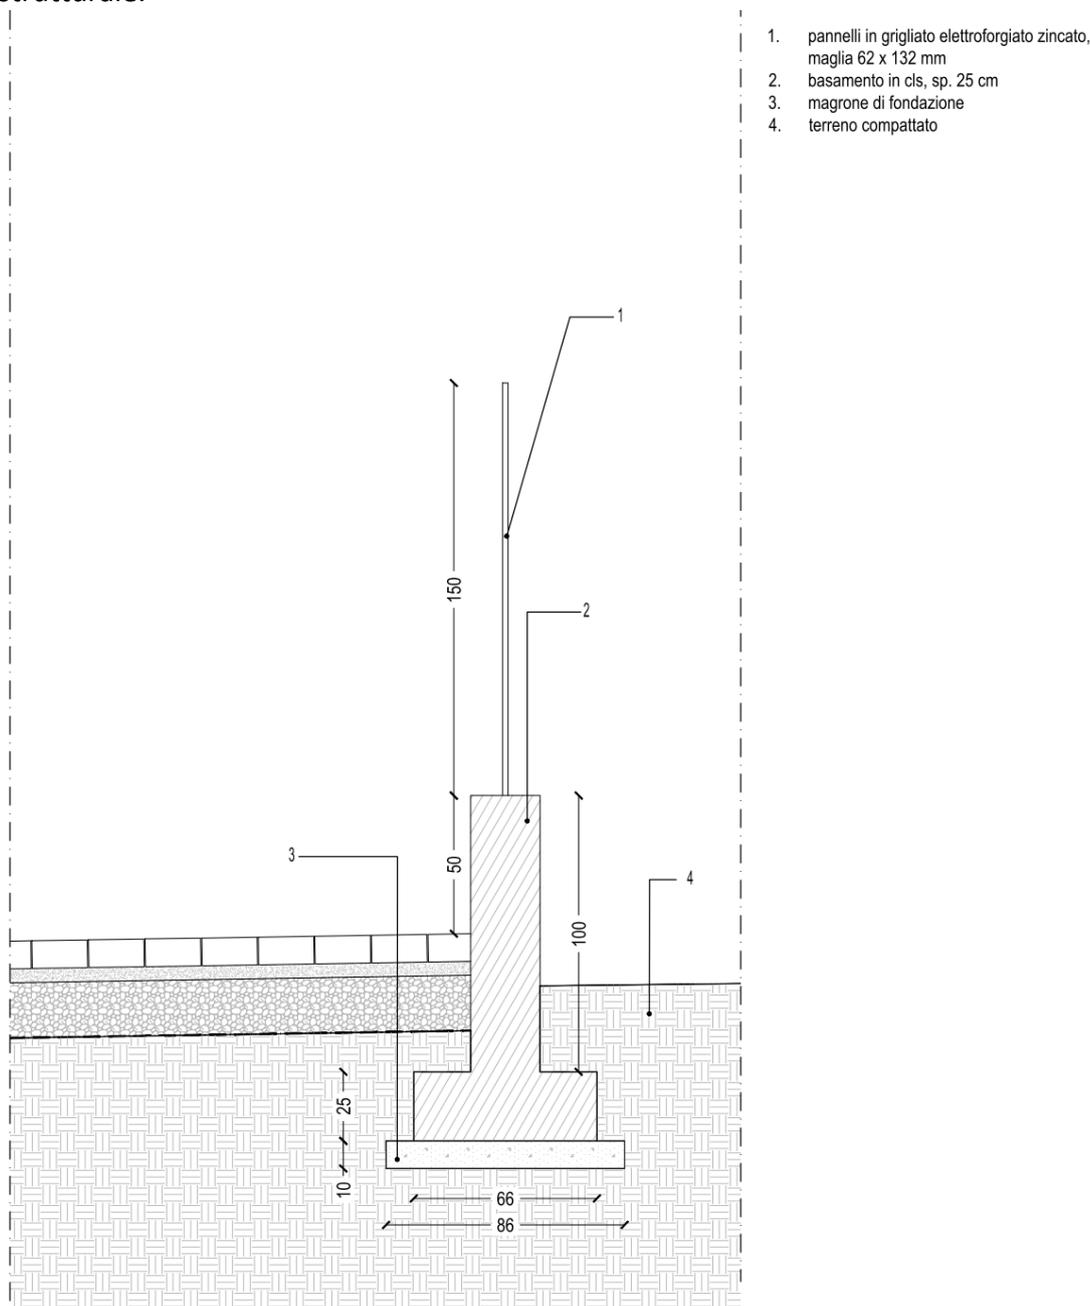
Sezione della recinzione (estratto tavola dettagli)
